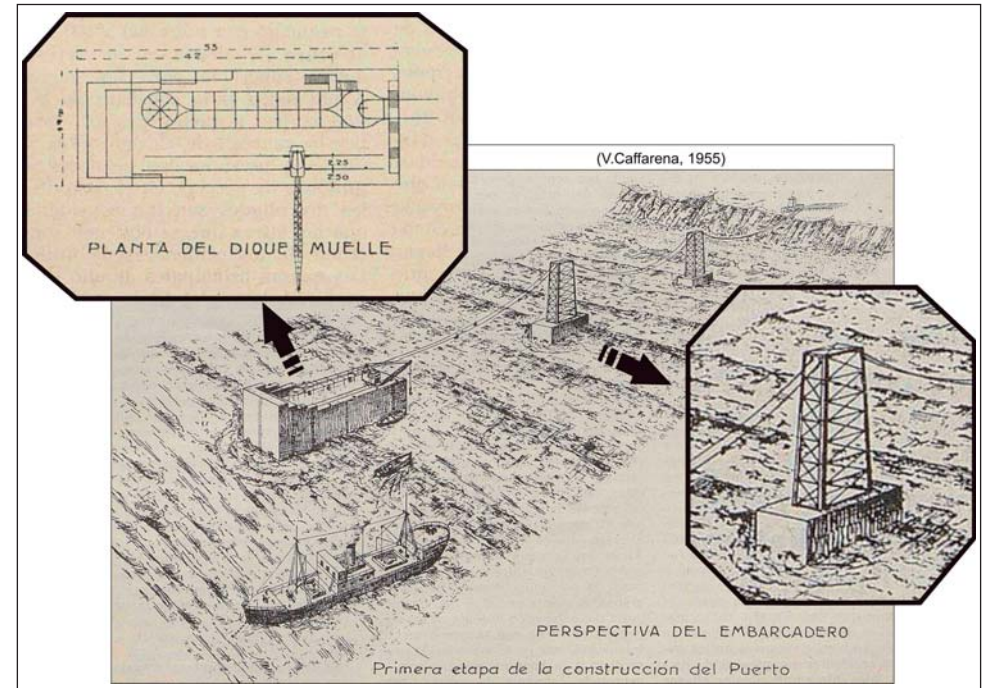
Plano del proyecto con el empleo de torres metálicas en los apoyos intermedios del teleférico convencional, y planta del dique muelle con la grúa sobre raíles (CAFFARENA 1955:109-110).
